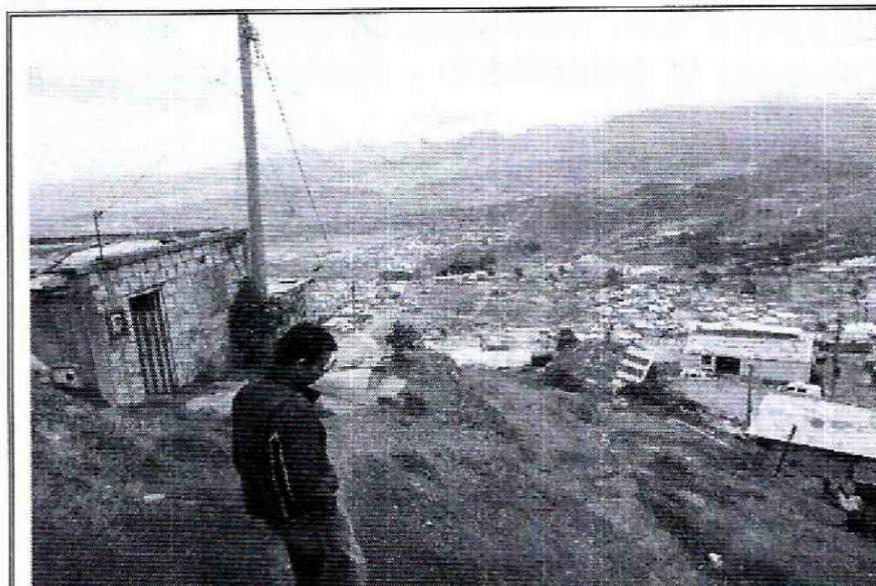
Vía de acceso peatonal a la vivienda emplazada en el predio de la Calle 81G Sur No. 19 – 53, en el Barrio Arabia, de la Localidad de Ciudad Bolívar.
